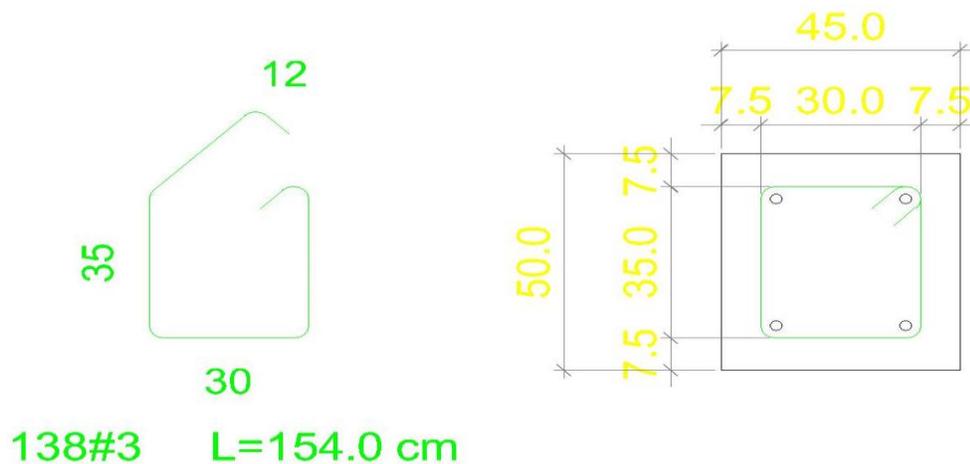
Despiece viga 136. (Fuente: Plano estructural MEISA)
